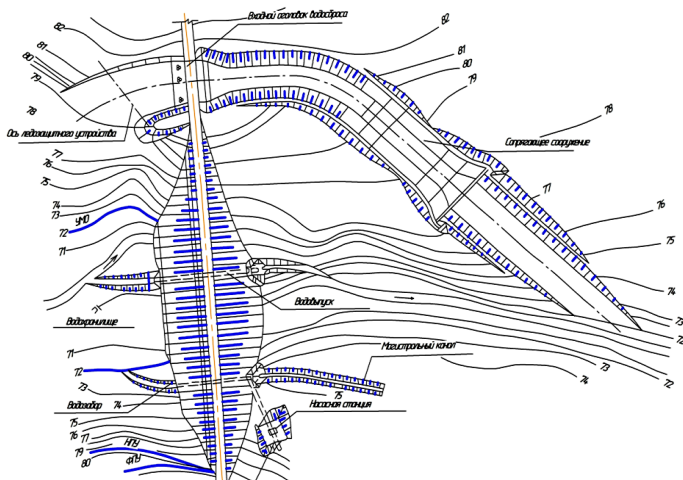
Вариант компоновки водохранилищного гидроузла
